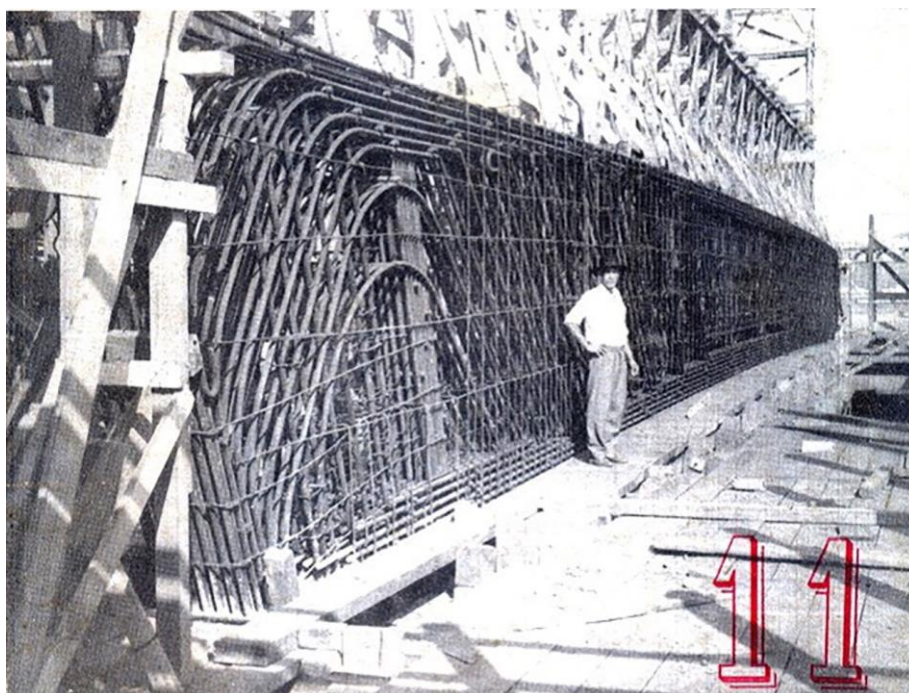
MAM-Rio. Revista Estrutura, 1958: detalhe de armação da viga do pórtico superior. (THOMAZ, 20 – ?).
